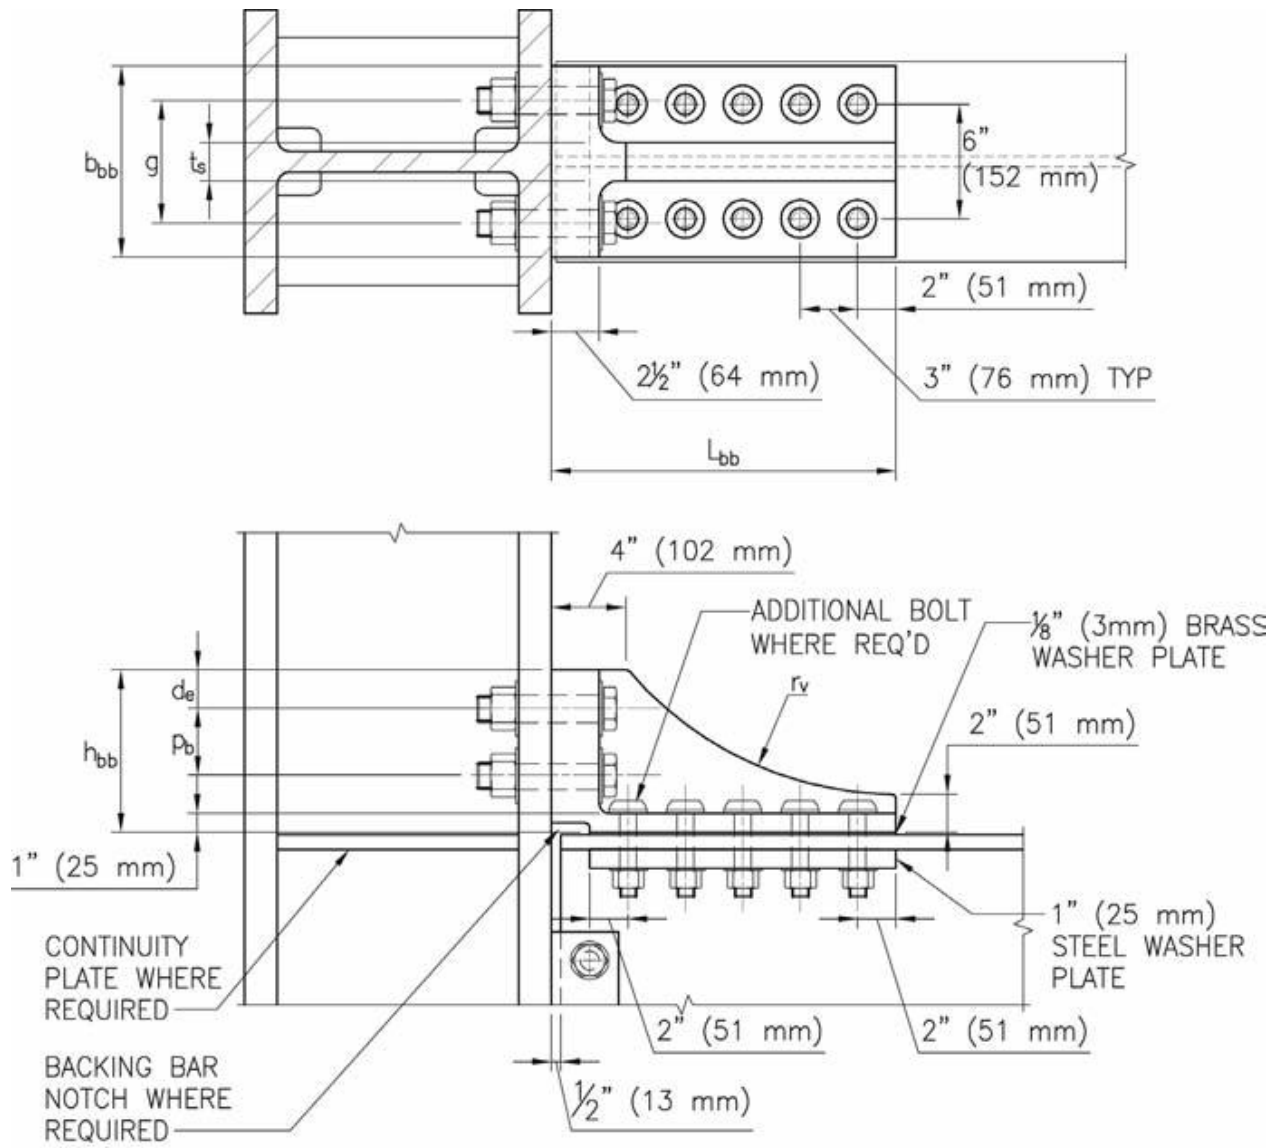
Detalles de conexión para la serie B. (AISC 358-10)
